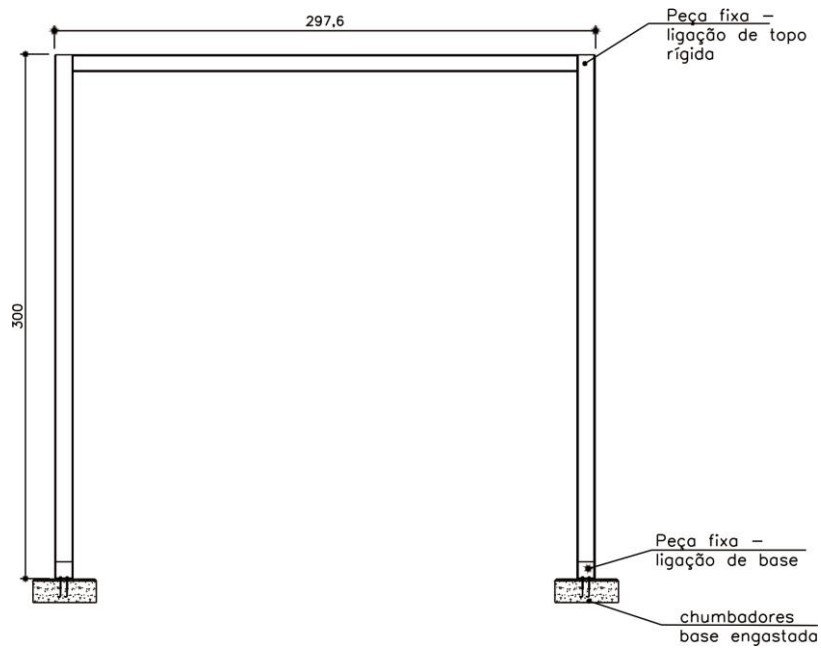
Elevação de um dos pórticos do módulo de pórticos.
